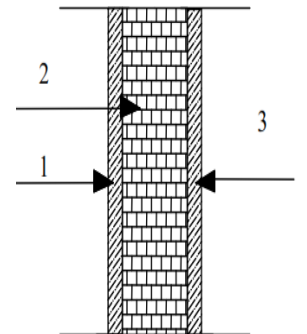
Coupe verticale d'un mur extérieur
